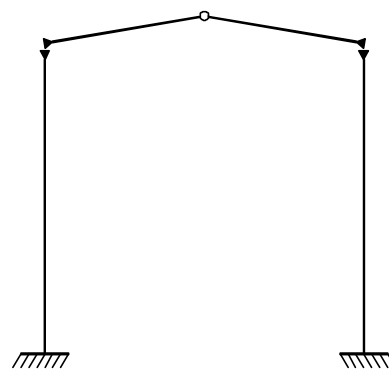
Pilar engastado na fundação e elementos de cobertura articulados entre si e engastados nos pilares (apud EL DEBS, 1996).
